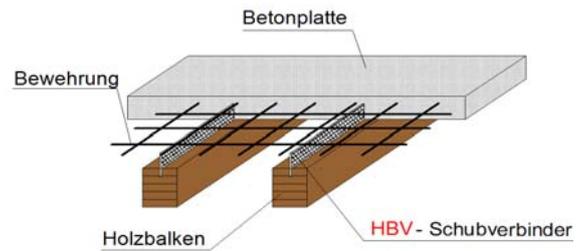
Ausführungsvarianten bei Holz-Beton-Verbunddecken im Neubau
